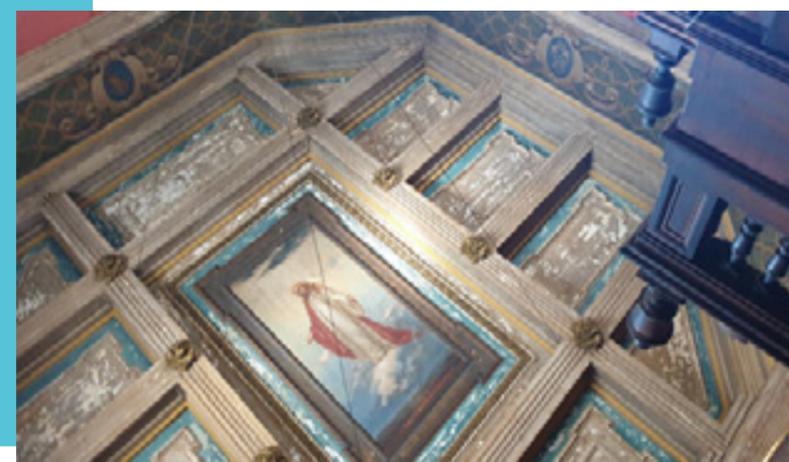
Chiesa di San Giovanni Battista - particolare soffitto sacrestia
